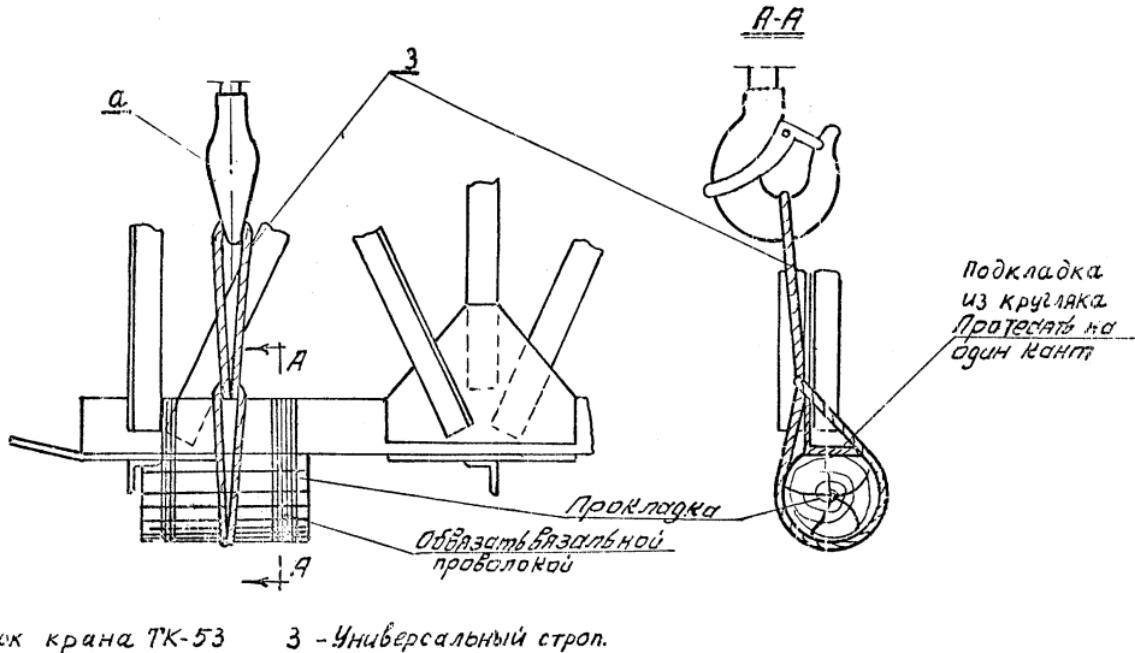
Узел стропления опоры У110-1 к крюку крана
